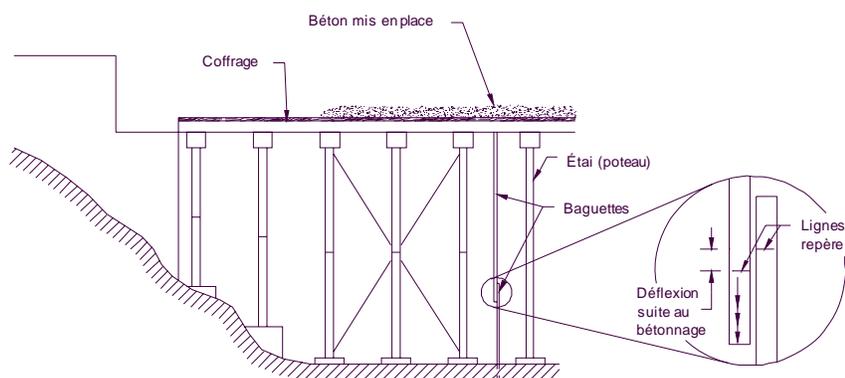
Contrôle de déflexion d'un étaielement lors du bétonnage d'un tablier
